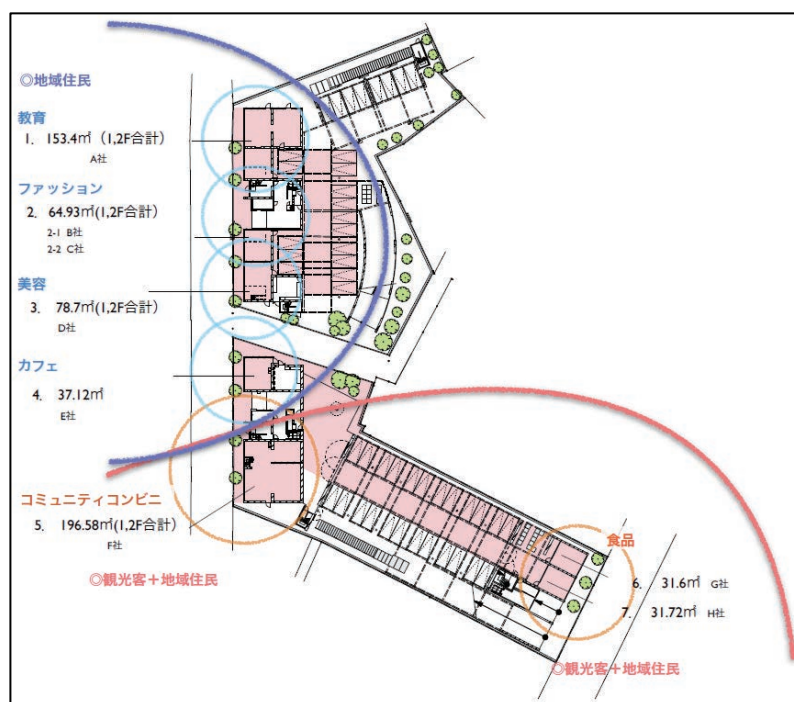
中央三丁目1番地区市街地再開発事業商業施設 1階平面図
